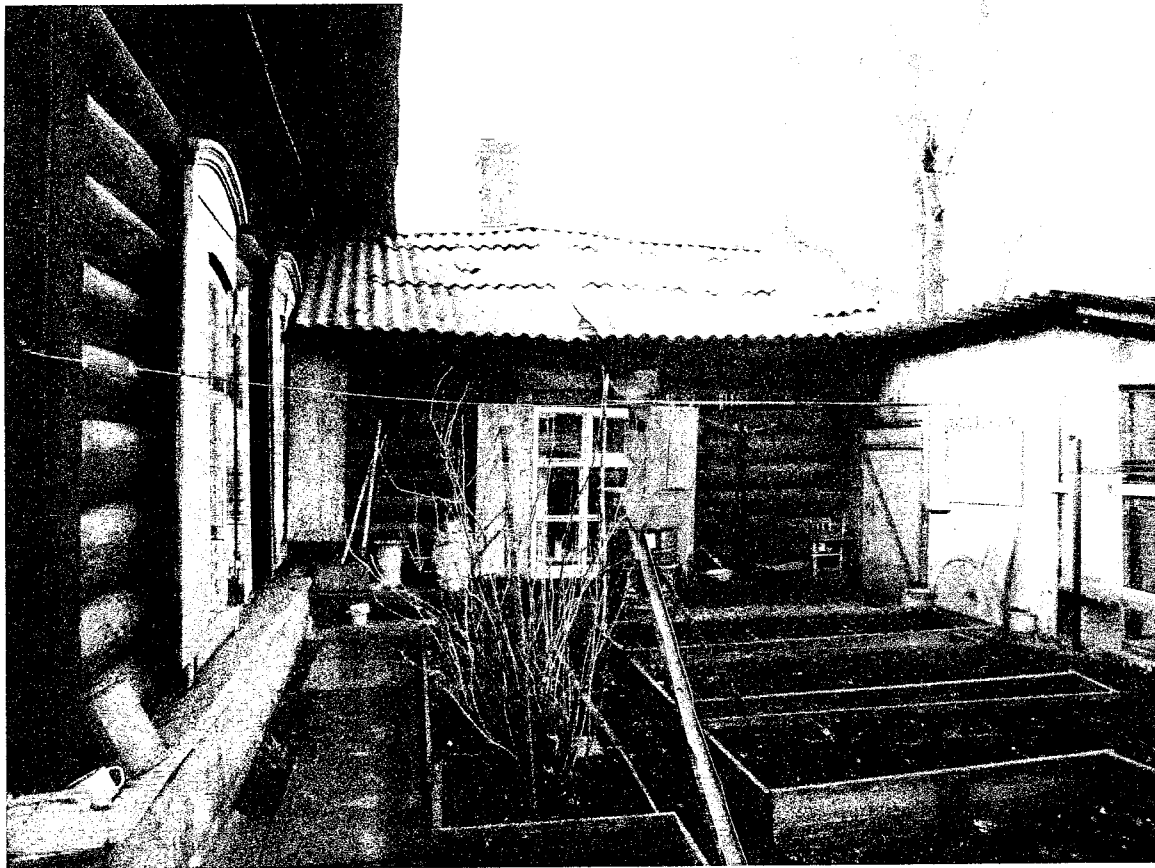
Фрагмент юго-восточного фасада прируба лит. А1
